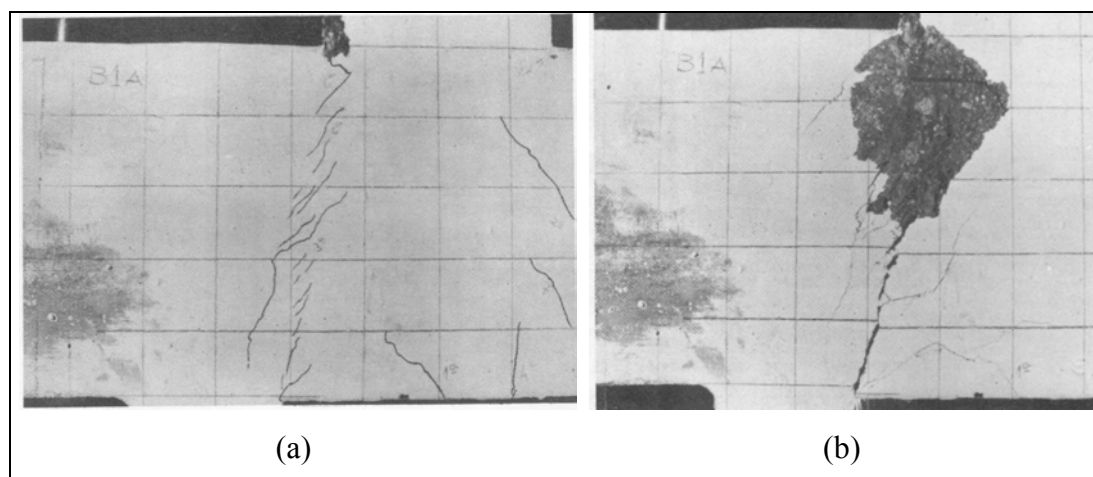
(a) Panorama de fissuração para a carga de 780 kN e (b) panorama de fissuração para a carga de 800 kN (ruptura)
